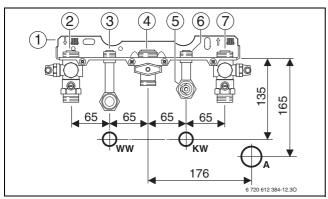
Aufputzanschlüsse mit Wandabstand 60 mm
